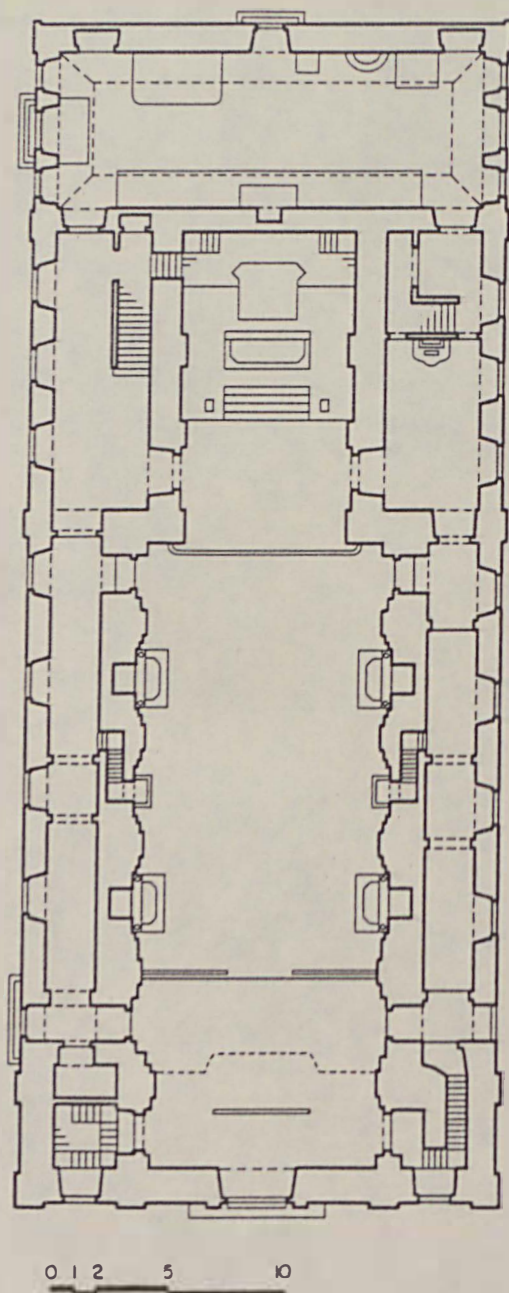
Planta da Igreja de São José, Rio de Janeiro (1808).
